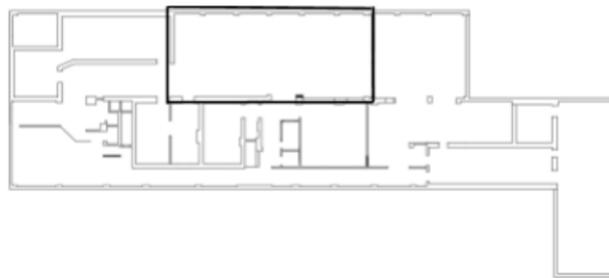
Planta baja - Recuadro de layout a detallar.
